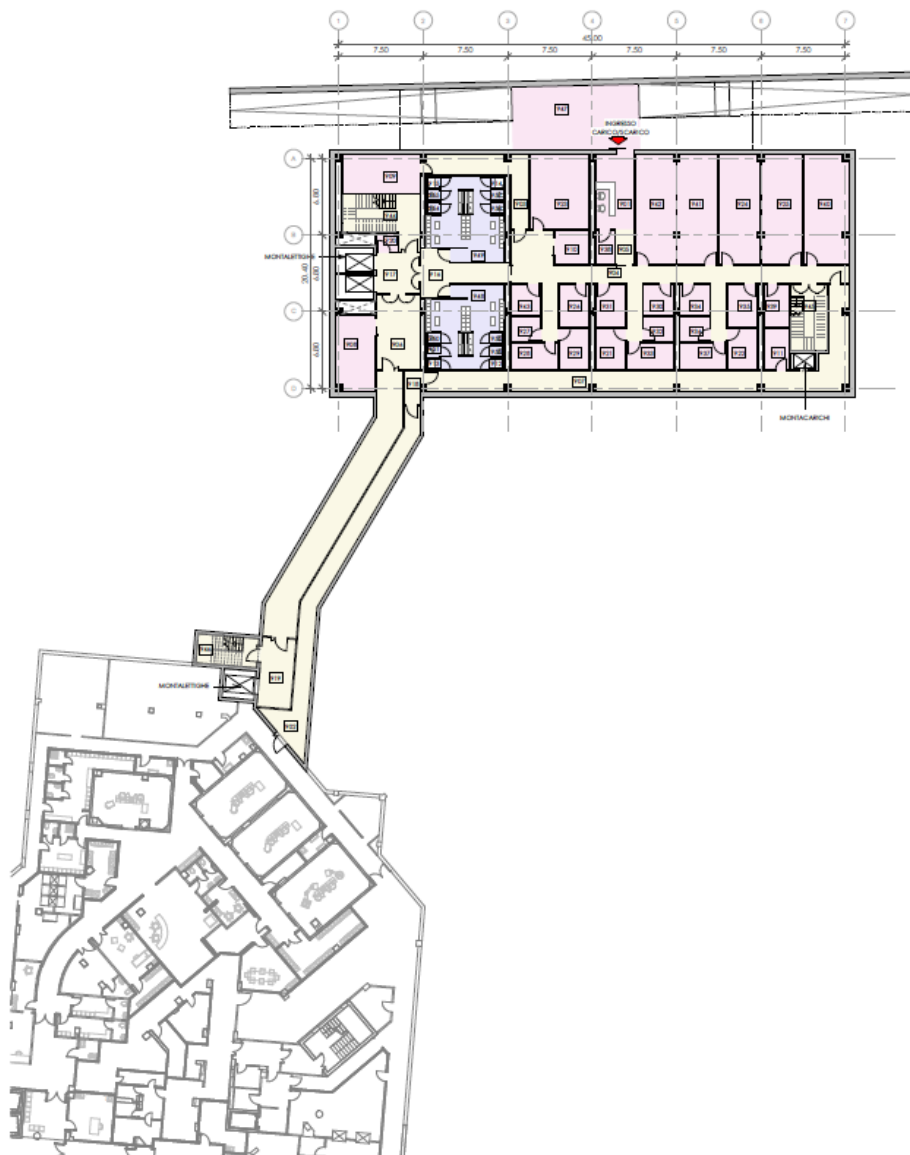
Pianta piano interrato dello stato di progetto preliminare.
